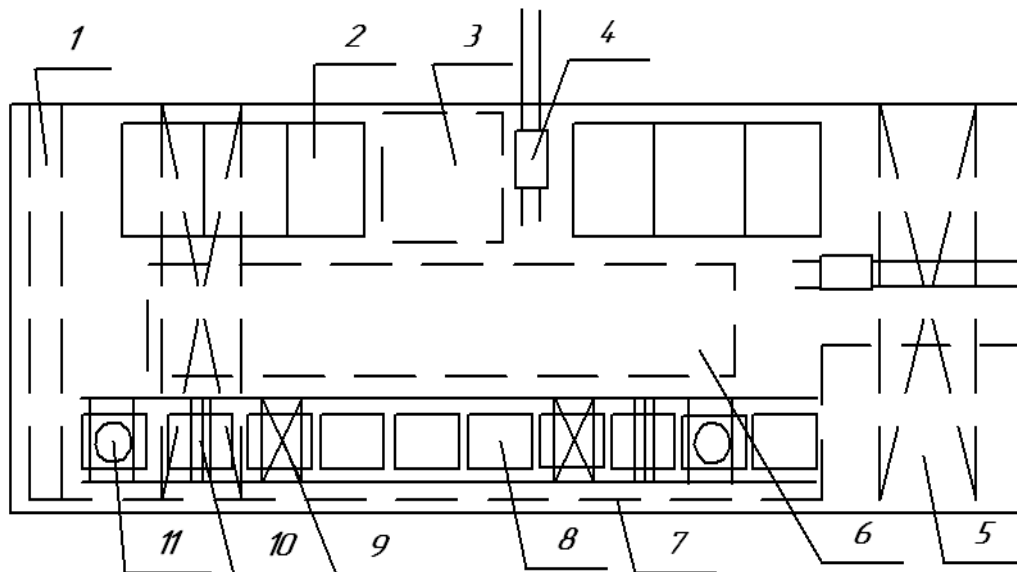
Схема полустенового производства наружных стеновых панелей:
